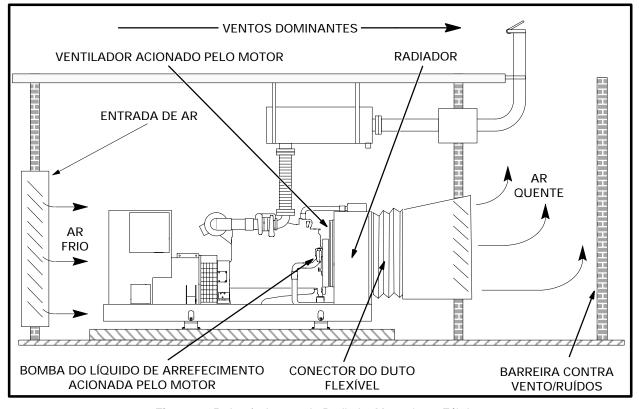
Arrefecimento do Radiador Montado na Fábrica
